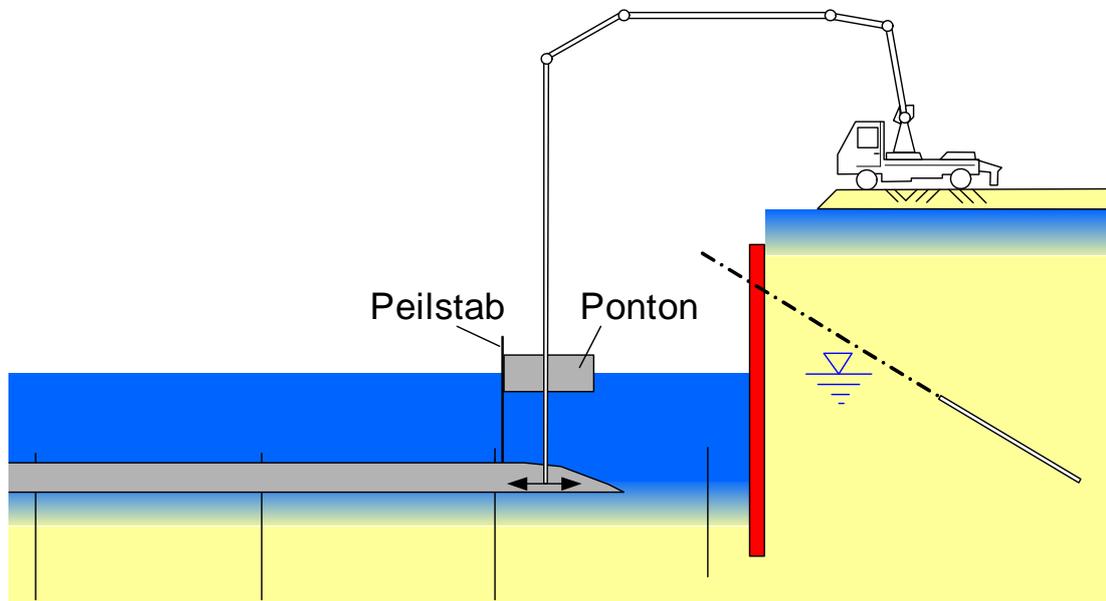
Betonieren mit Contractor-Verfahren - Betonierrohr am Ponton geführt [18], S. 414
